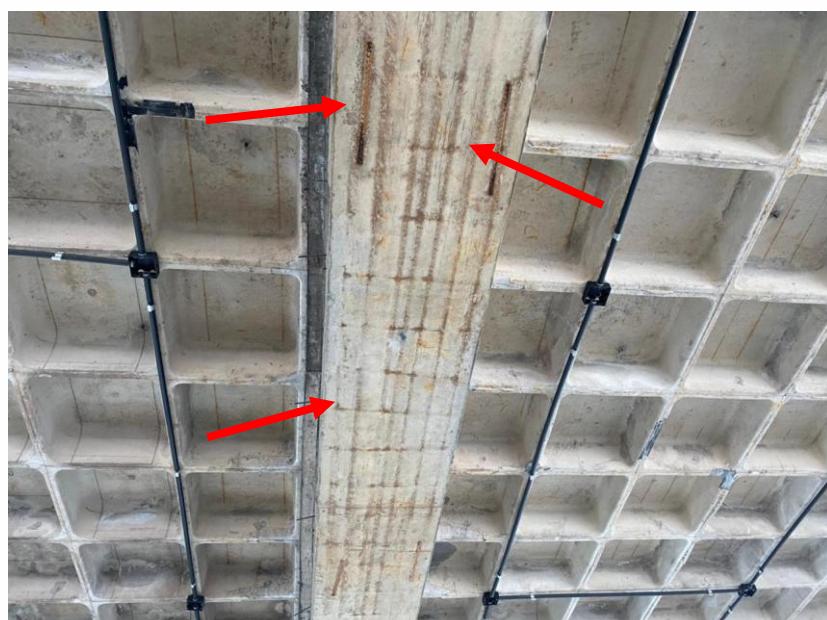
Ferragem exposta na face inferior da viga e sinais de oxidação da armadura ao longo do comprimento.
